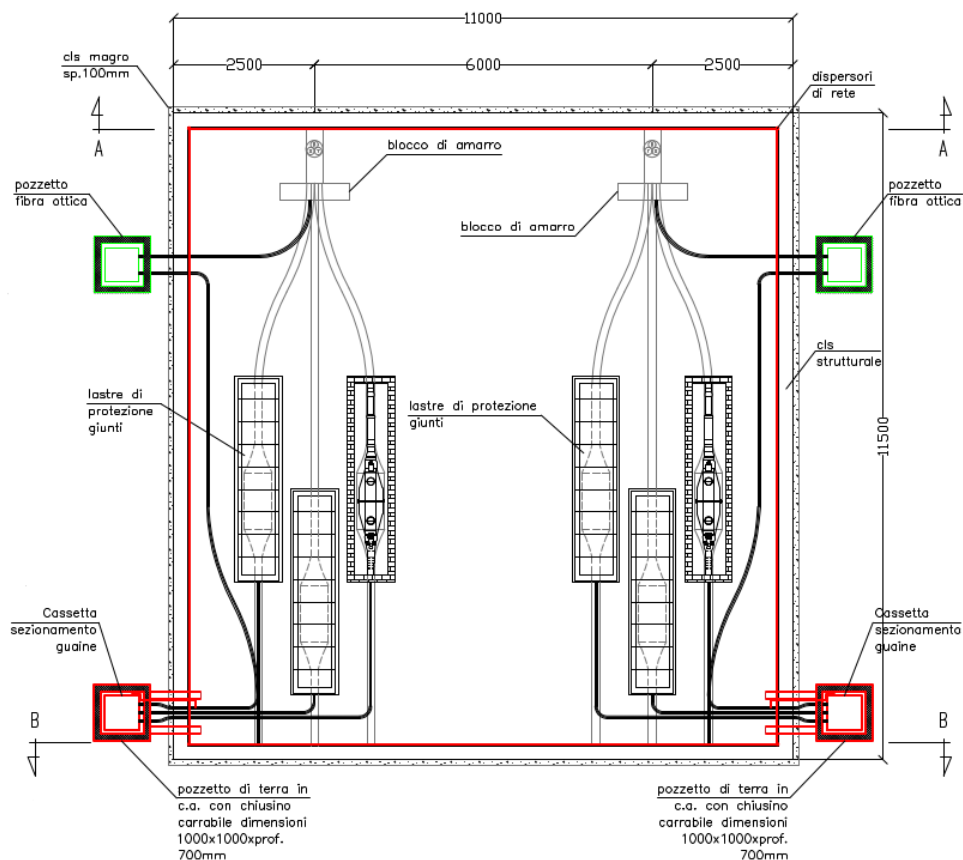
Geometria generale vasca dei giunti di transizione: pianta
